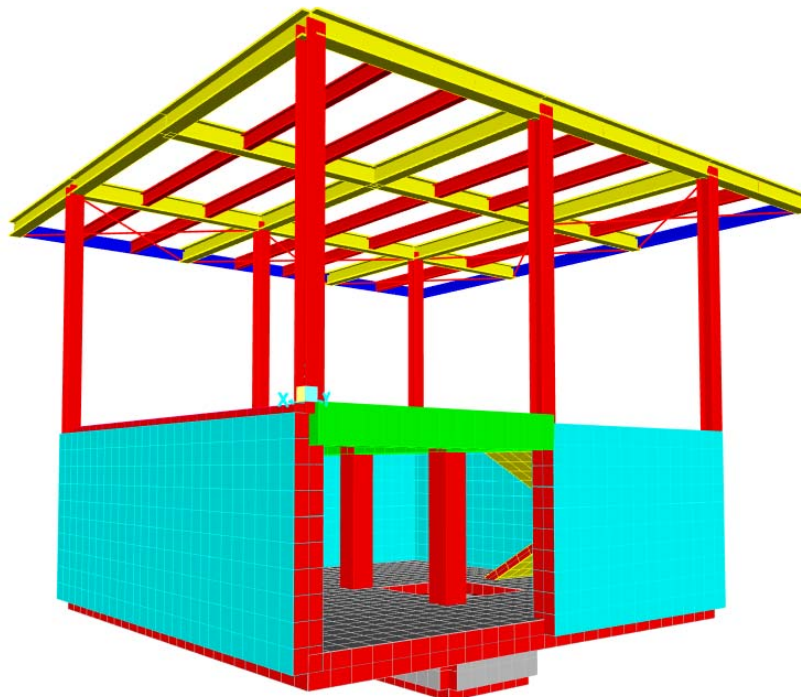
Vista assometrica modello struttura elevazione/fondazione
